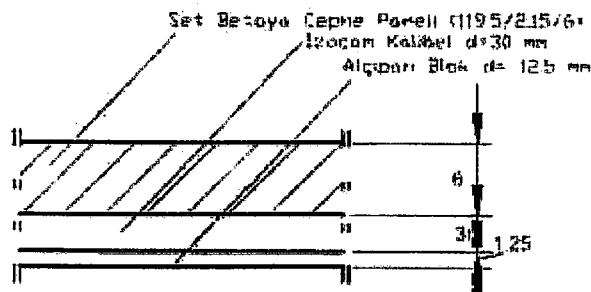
Boy kesit (Set Betoya, 1999)
